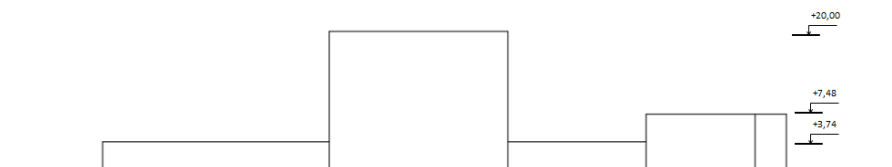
Perfil Avenida Martin Tovar fuente: La autora (2022)
